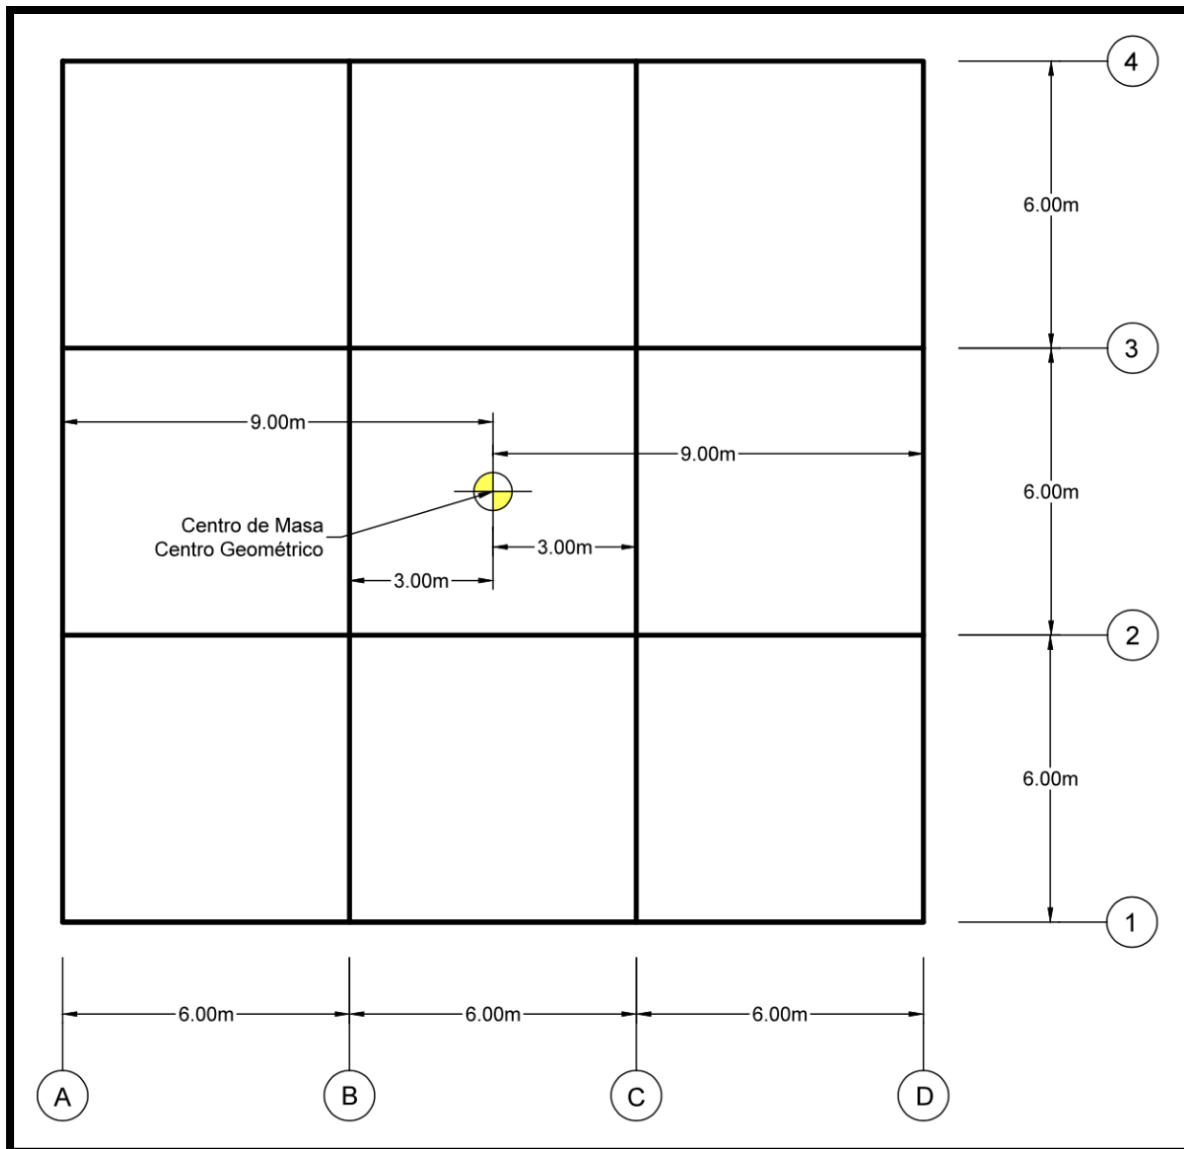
Vista en planta de la estructura, centroide. (Elaborado por el autor, 2017)
